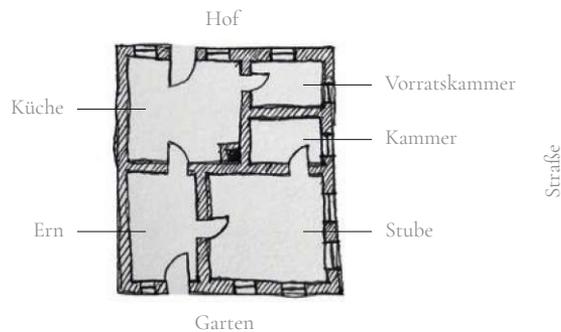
Skizze, Grundriss Erdgeschoss um 1660
